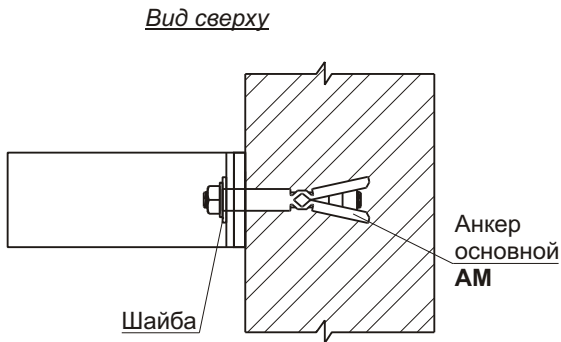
Крепление кронштейна КРУ к стене одним основным анкером
